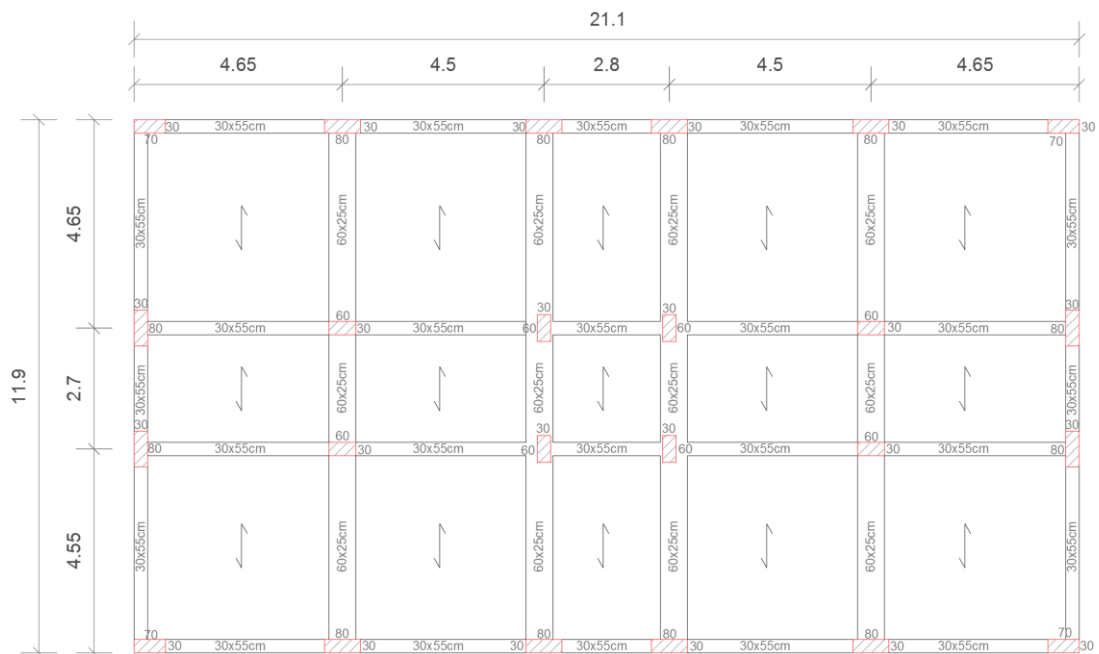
Carpenteria solaio di sottotetto struttura in c.a. a due piani.
